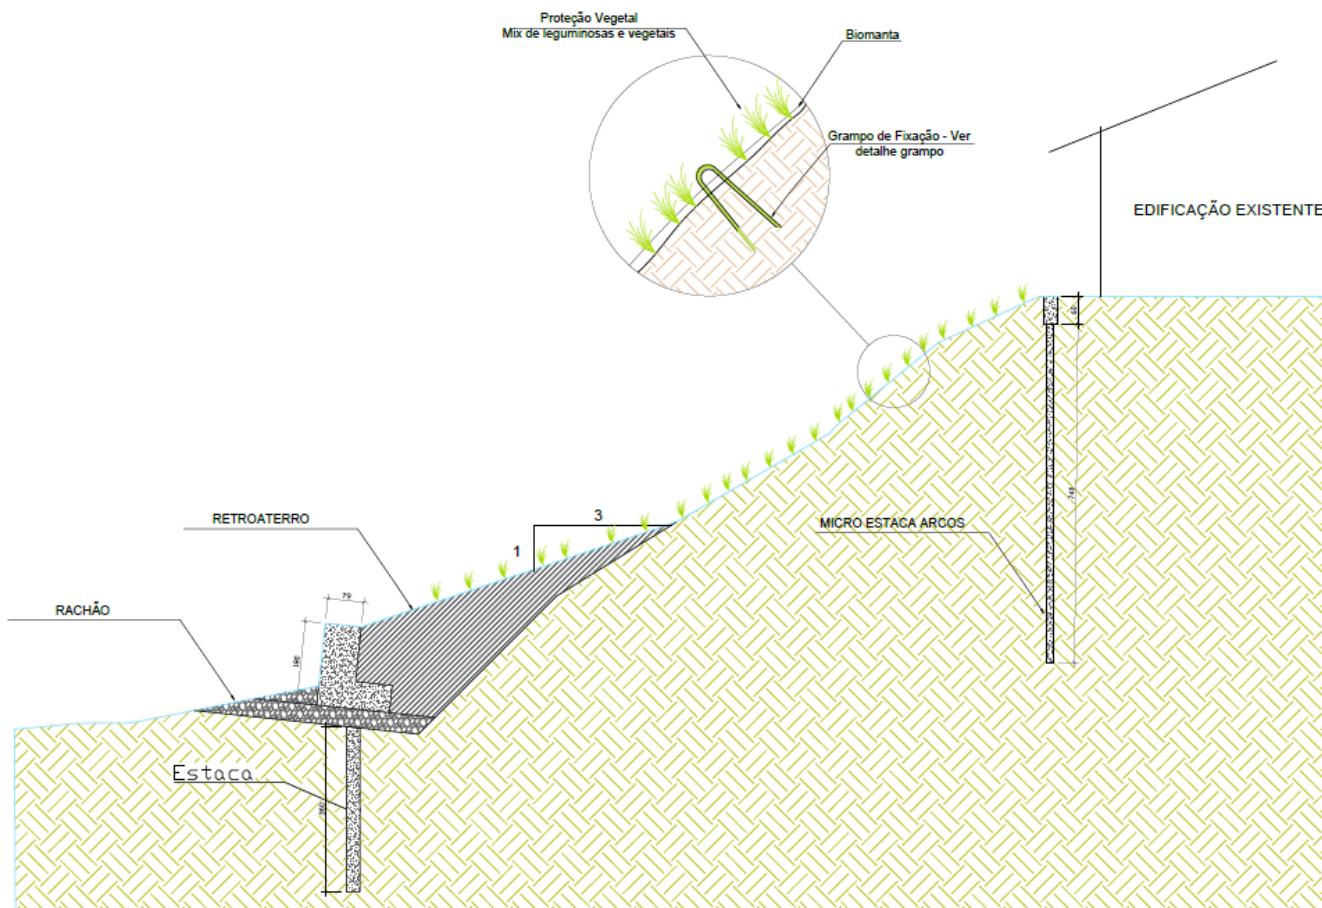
Corte esquemático da seção crítica de projeto apresentando as estruturas propostas para estabilização.
